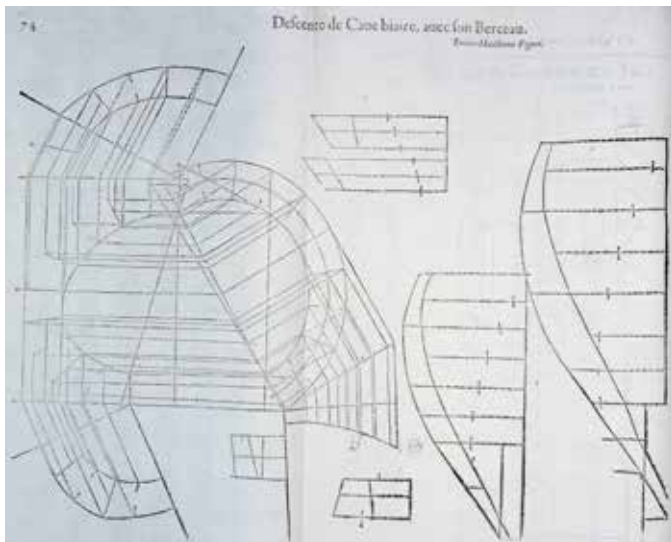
M. Jousse, « Descente de cave biaisée avec son berceau » (in JOUSSE, *Le secret d'architecture... cit.*, p. 74 ; © Architectura CESR).
